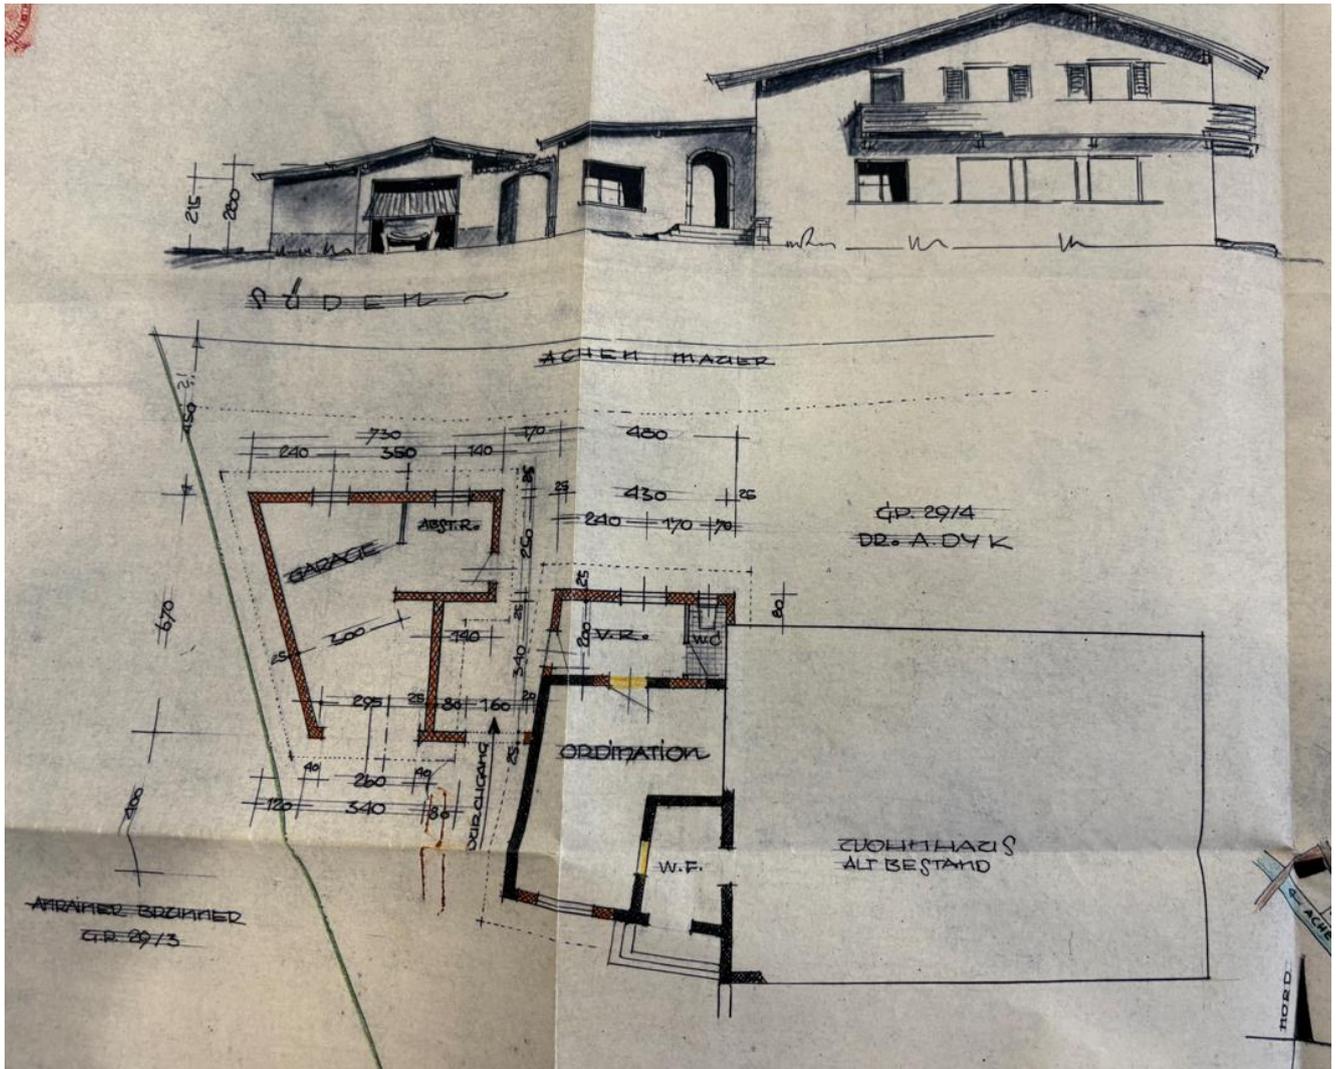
Grundriss Anbau Garage (Baujahr 1976)²¹
